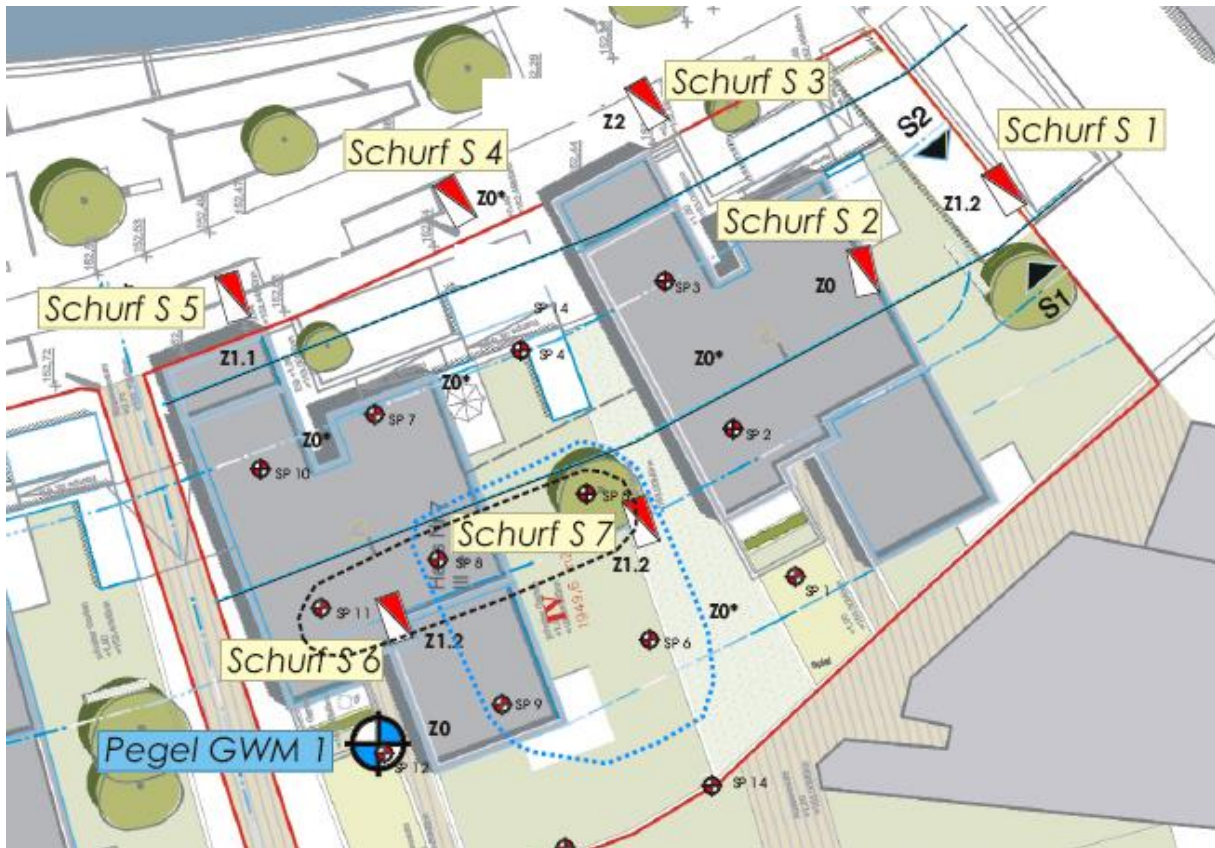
Plan mit Lage der Erkundungspunkte und der Grundwassermessstelle GWM 1 (aus [2]).
